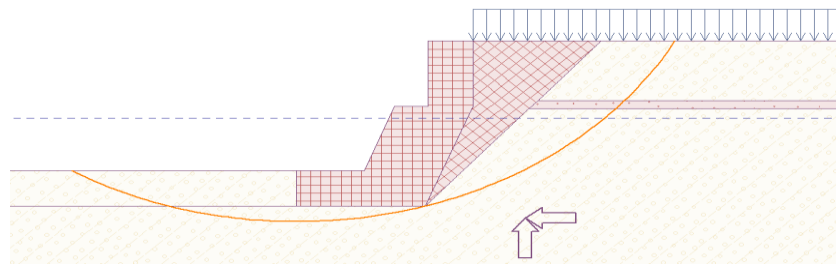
Vista en 3D del muro de mampostería con sistema terramesh
